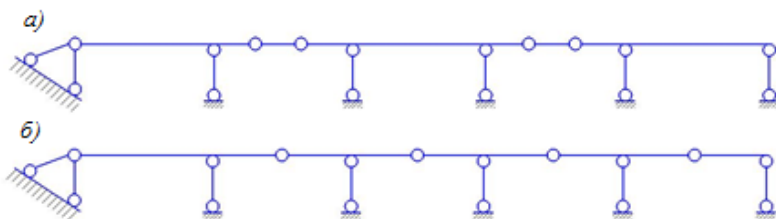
Расчетные схемы многопролетных шарнирных балок
